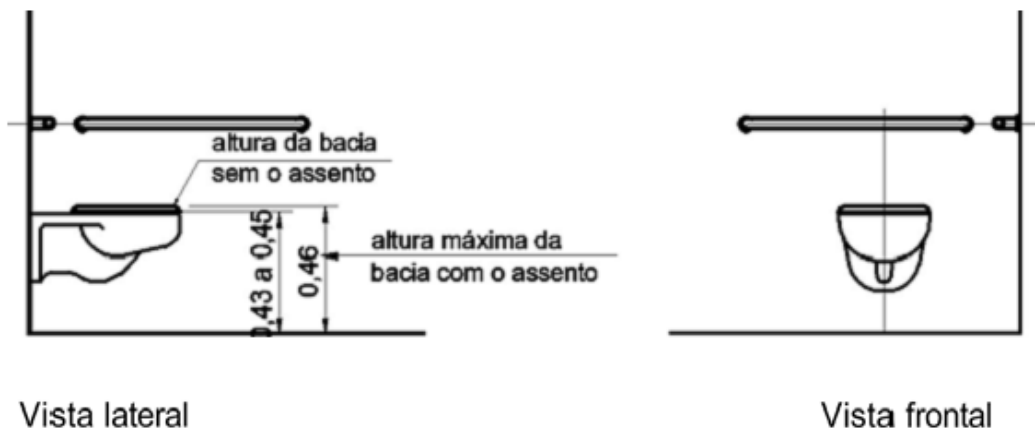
Bacia sanitária — Exemplo de Barra de apoio lateral com fixação na parede de fundo
